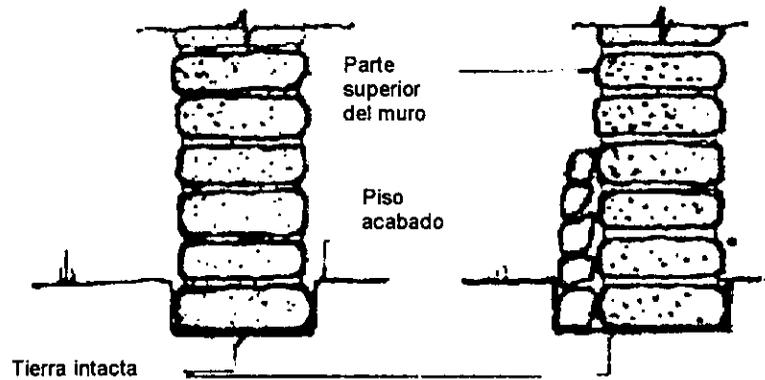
a) Levantamiento de muro desde una zanja sin cemento. Dibujo: McHenry Paul Graham, 1996.
